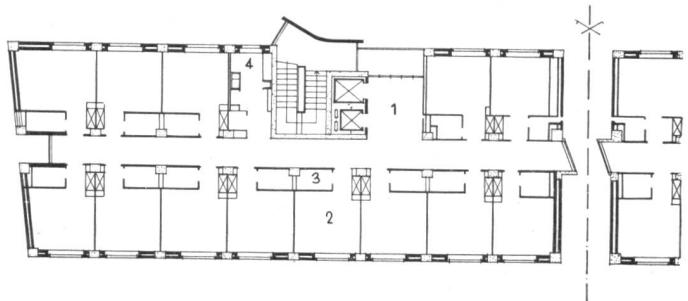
Hochhaus für Alleinstehende in Mailand. Wohnungsgrundriss Maßstab 1 : 400. Ganghochhaus mit innerem, neutralisiertem Korridor.
